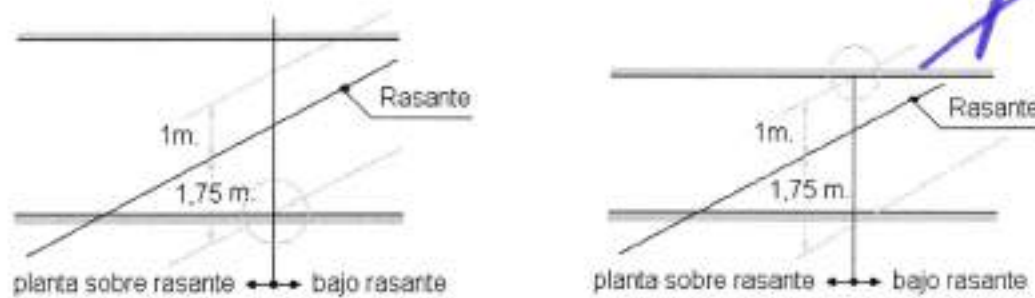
Determinación de planta sobre y bajo rasante
